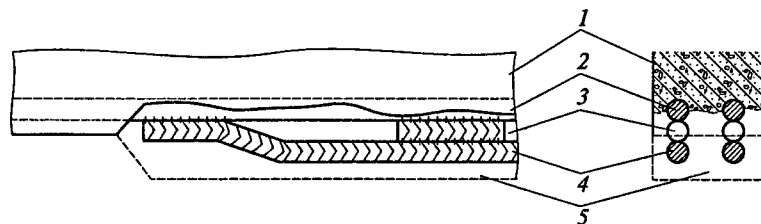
Добавление арматуры к железобетонному элементу:
